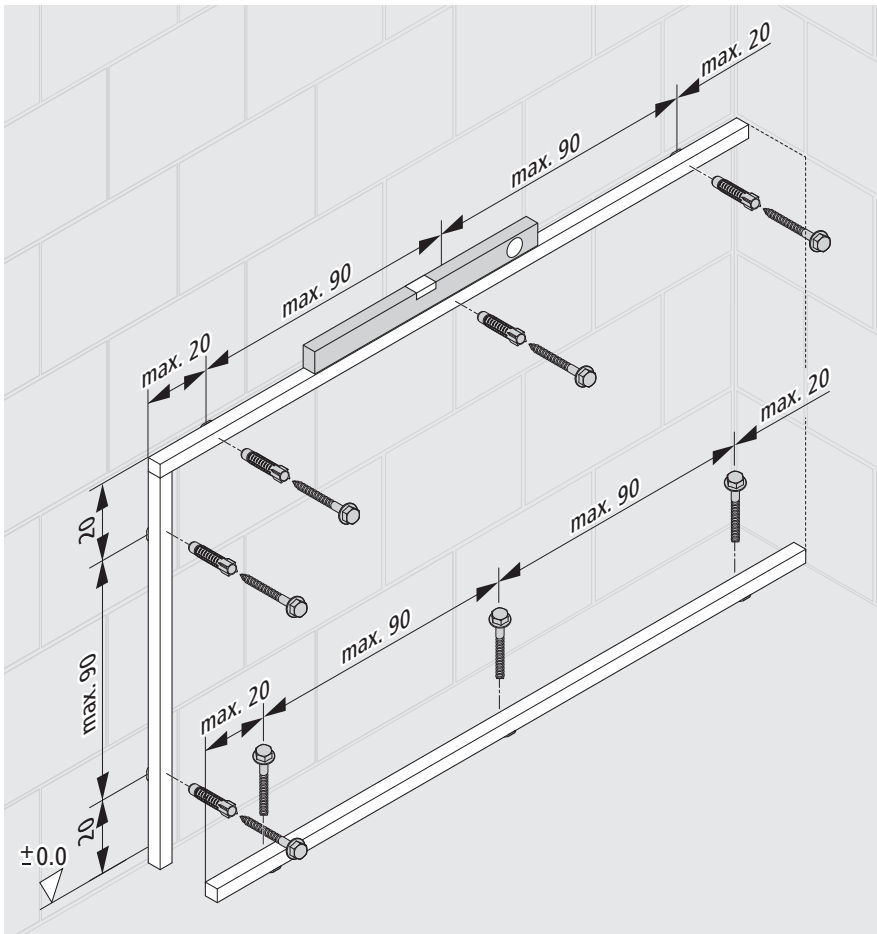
Dimensions de montage cadre de montage hauteur partielle, fixation sur le mur de soutien (paroi massive)
